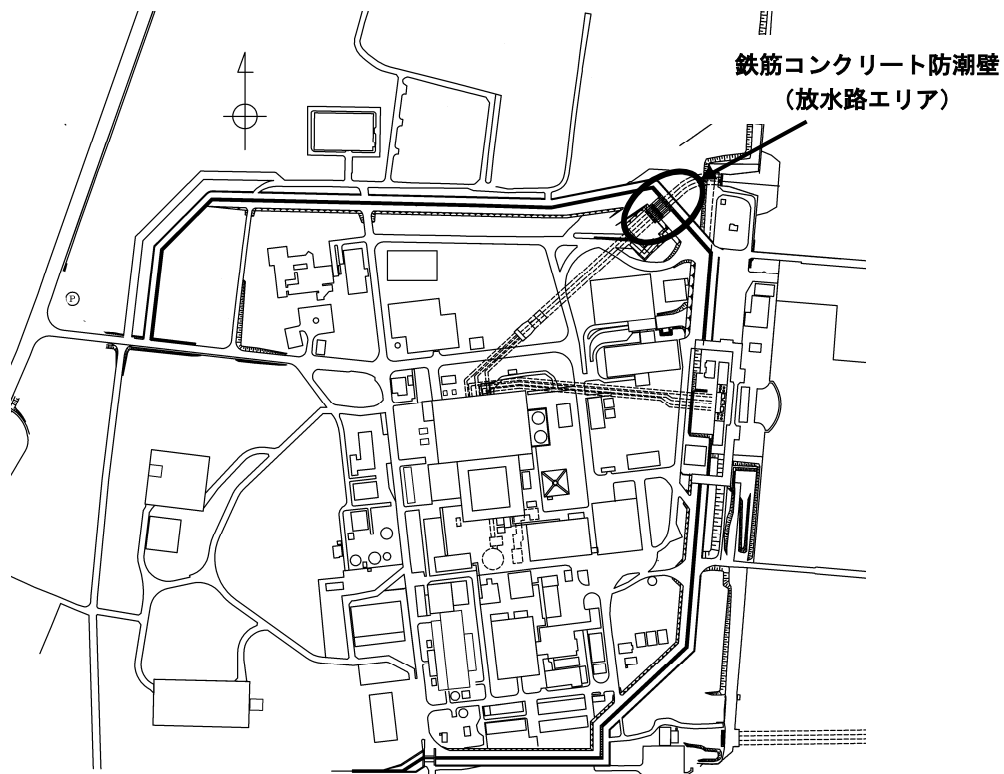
鉄筋コンクリート防潮壁（放水路エリア）の位置図
